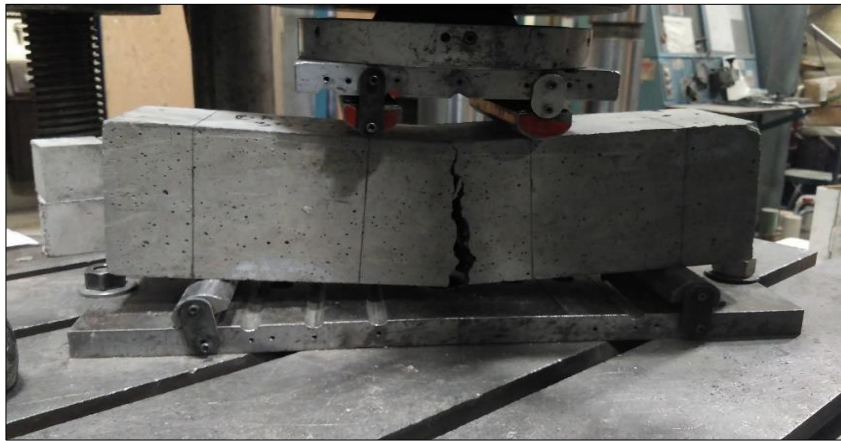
Poutre de (100x100x400 mm) lors l'essai de flexion
